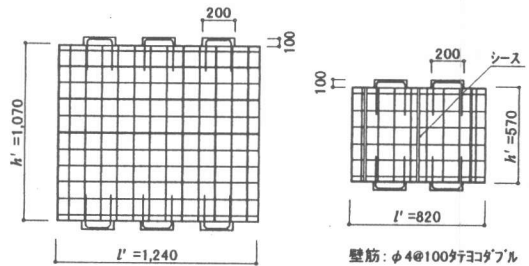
試験体 97PCWA の形状および配筋(単位:mm)
